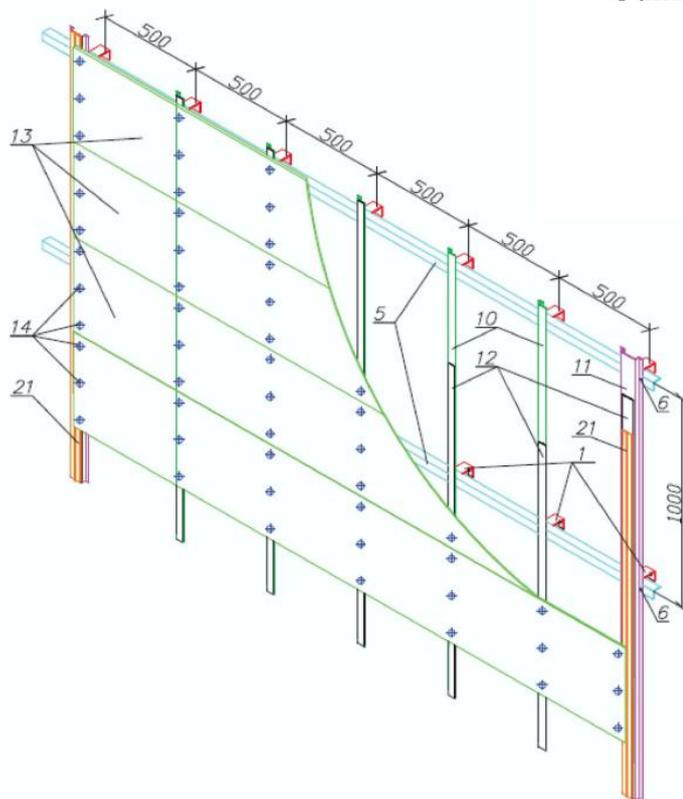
Конструкція вентиляруемого фасада: 1 – кронштейн; 2 – анкер; 3 – паронітова прокладка; 4 – стіна; 5 – горизонтальний профіль; 6 – шуруп 5,5 x 19; 7 – утеплювач; 8 – вітрозахисна мембрана; 9 – тарільчатий дюбель; 10 – вертикальний z-подібний профіль; 11 – стрічка ЕПДМ; 12 – фіброцементна панель Nichiha (14-18 мм); 13 – саморіз 3,9 x 32; 21 – стикувальна планка.
